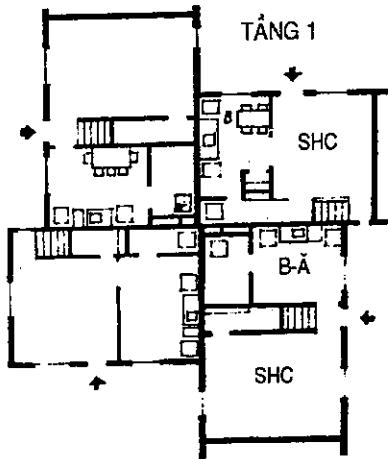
Sơ đồ kết cấu nhà ít tầng
